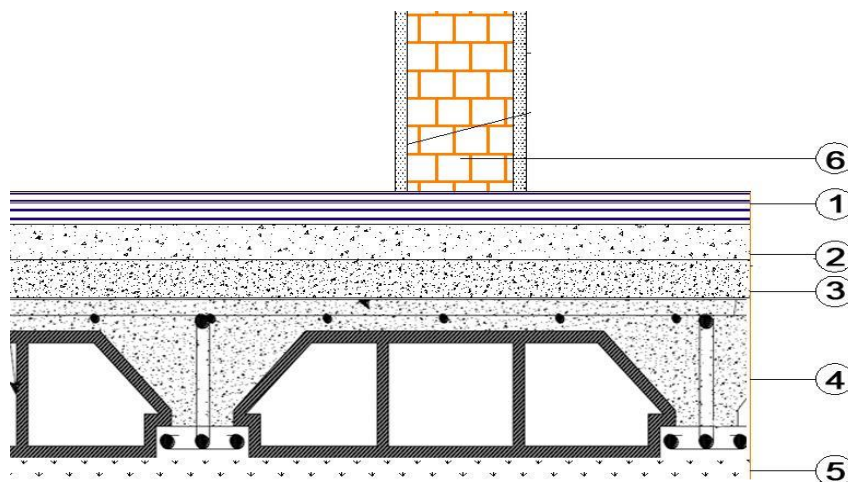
Coupe verticale d'un plancher d'étage courant.
